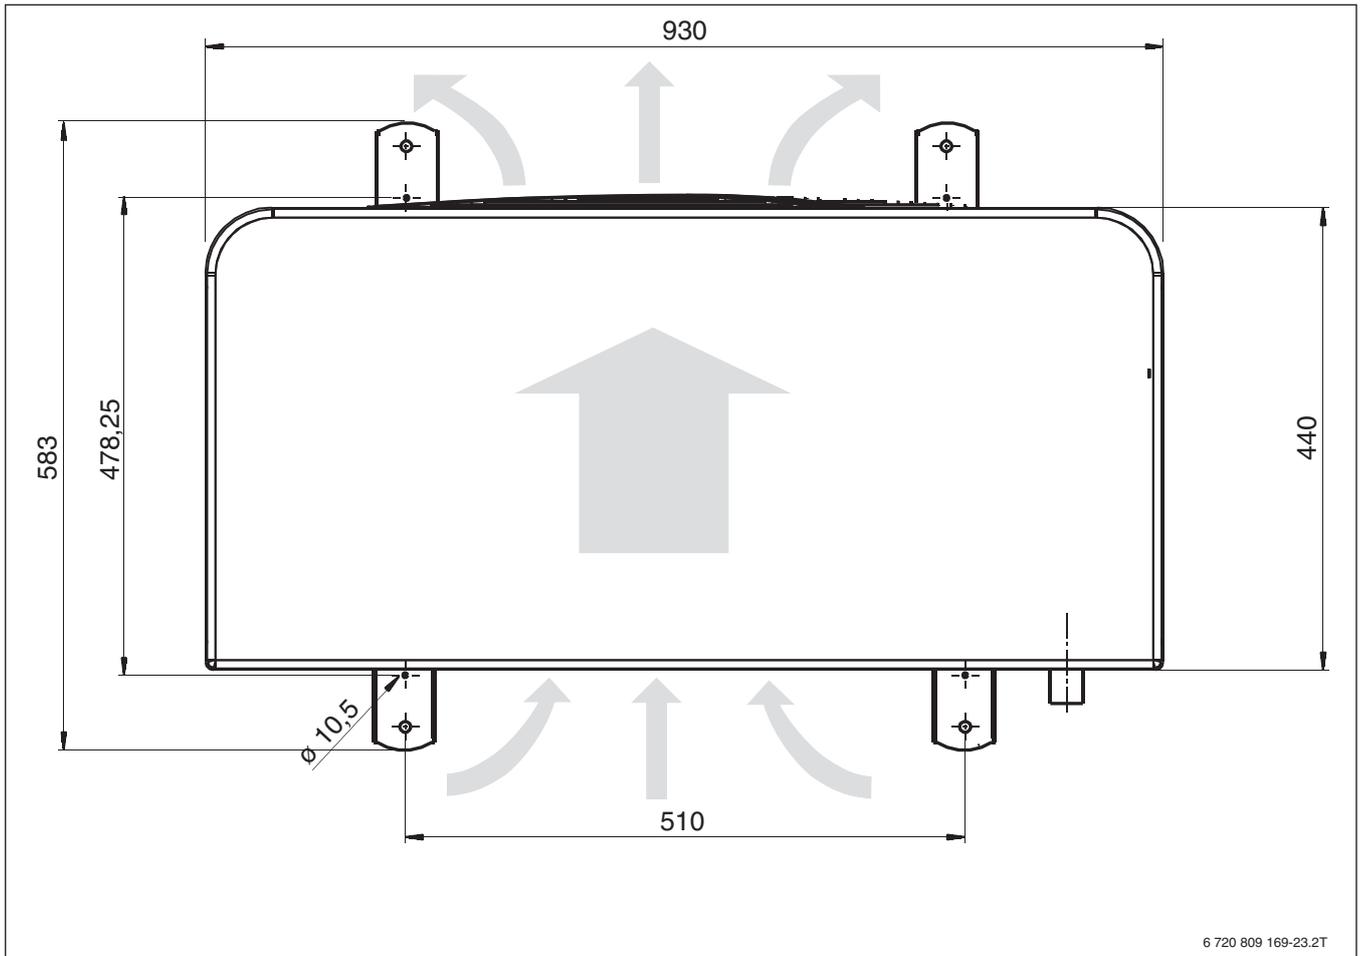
Abmessungen der Außeneinheit ODU W6/W8, Draufsicht
